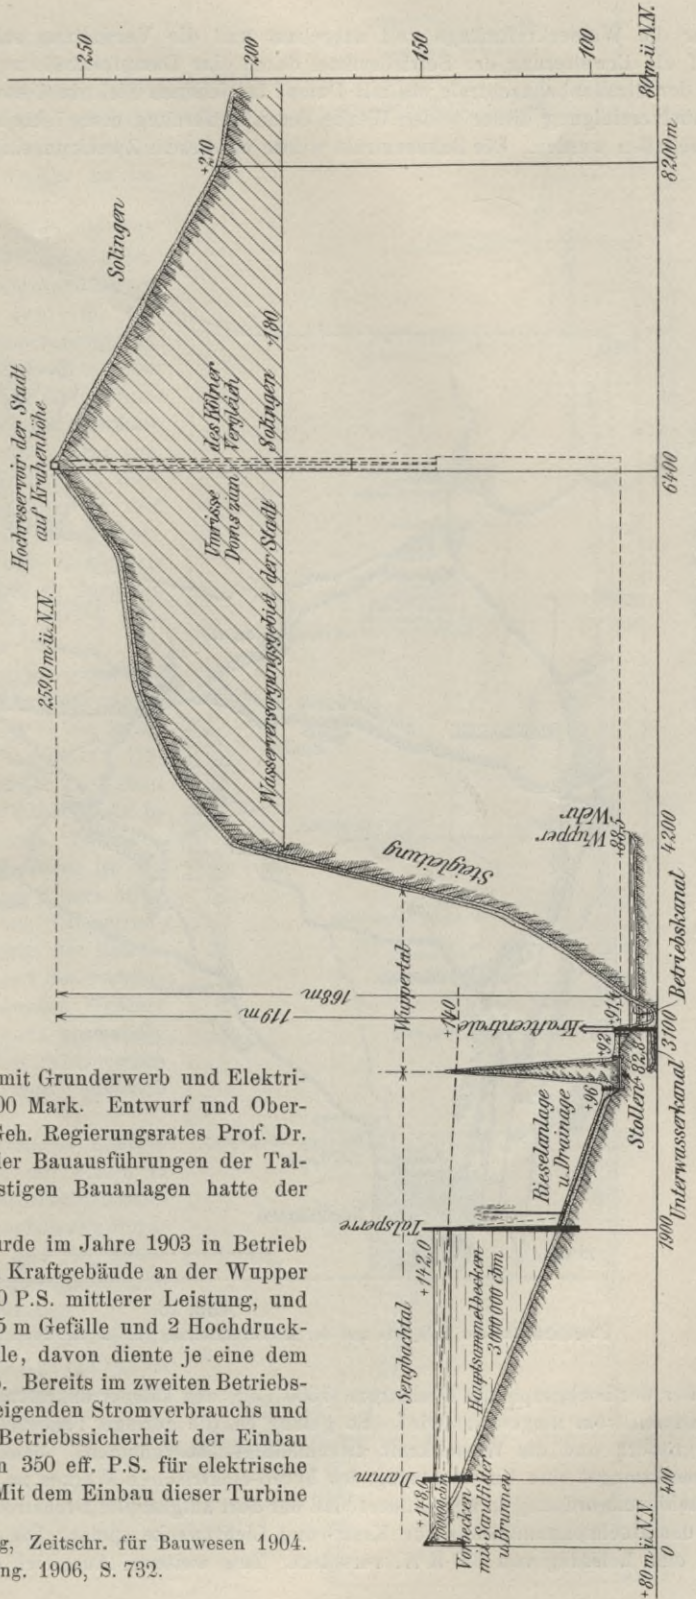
Höhenplan der Talsperren- und Wasserkraftanlage der Stadt Solingen.
